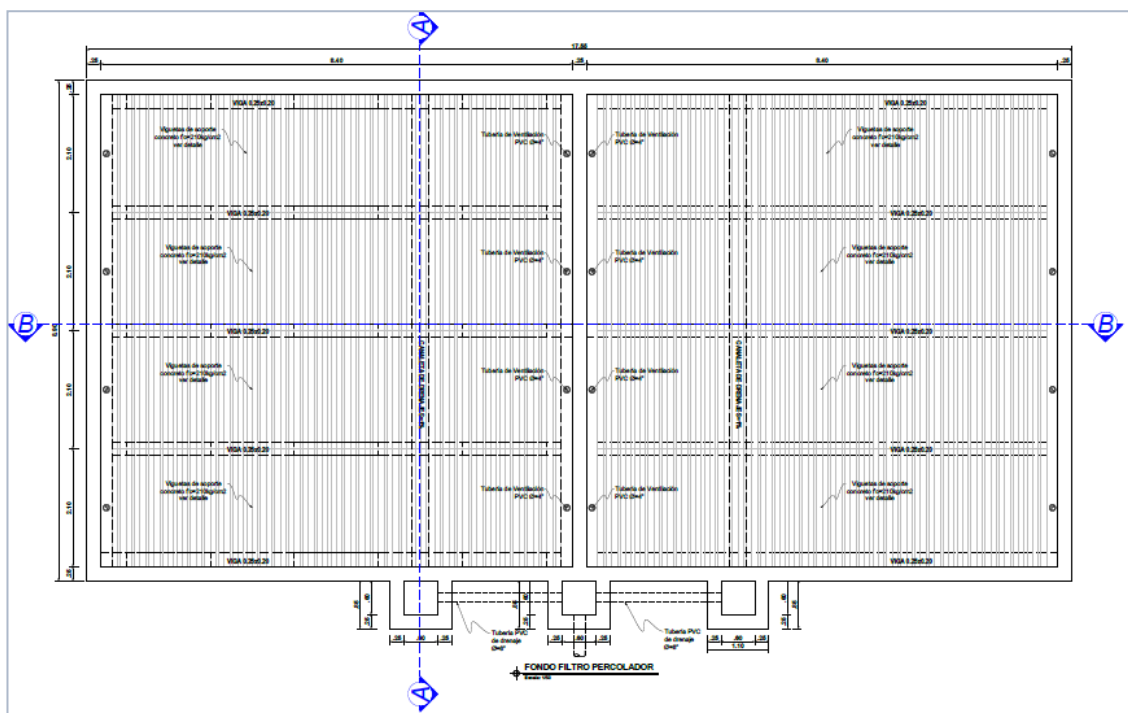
DETALLE DE FILTRO PERCOLADOR PLANTA
